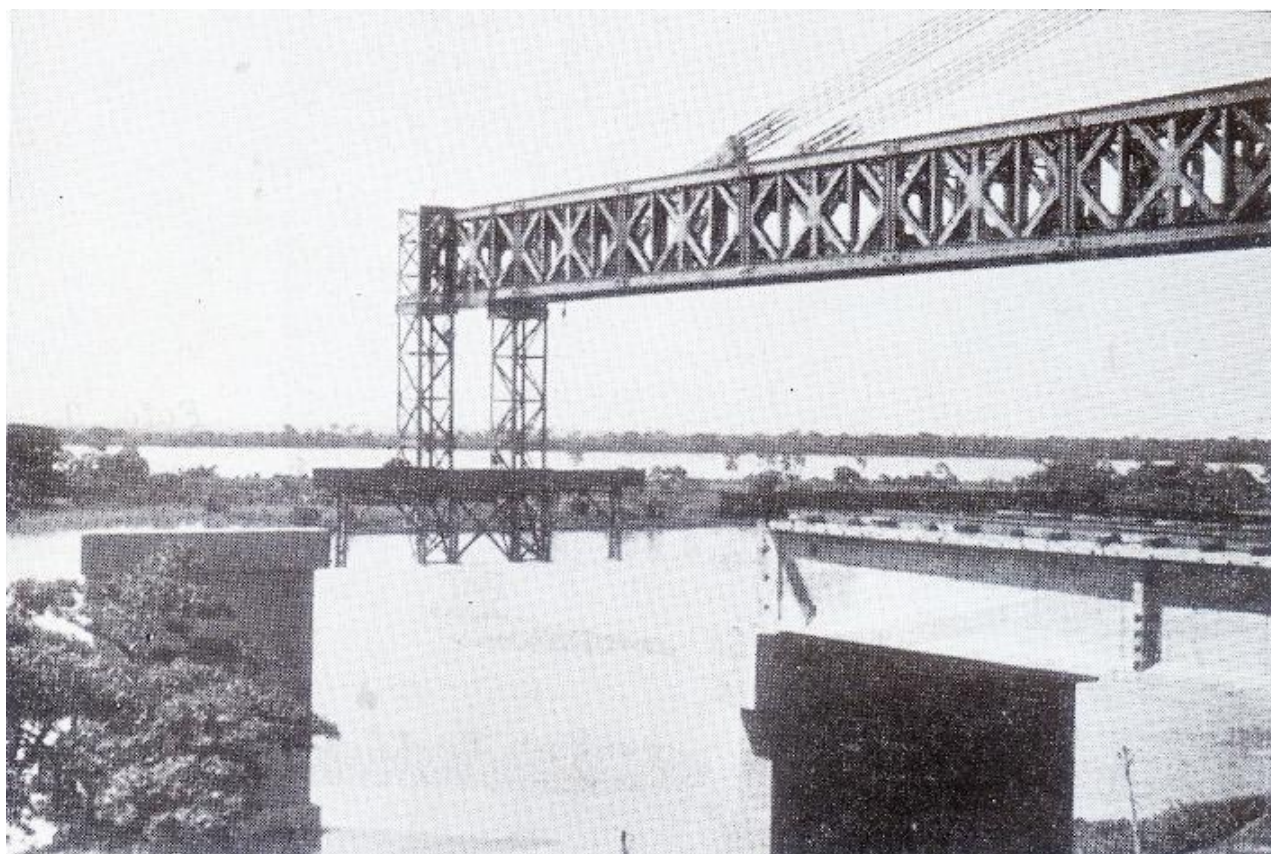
Deslocamento da treliça. Trecho dianteiro em balanço
